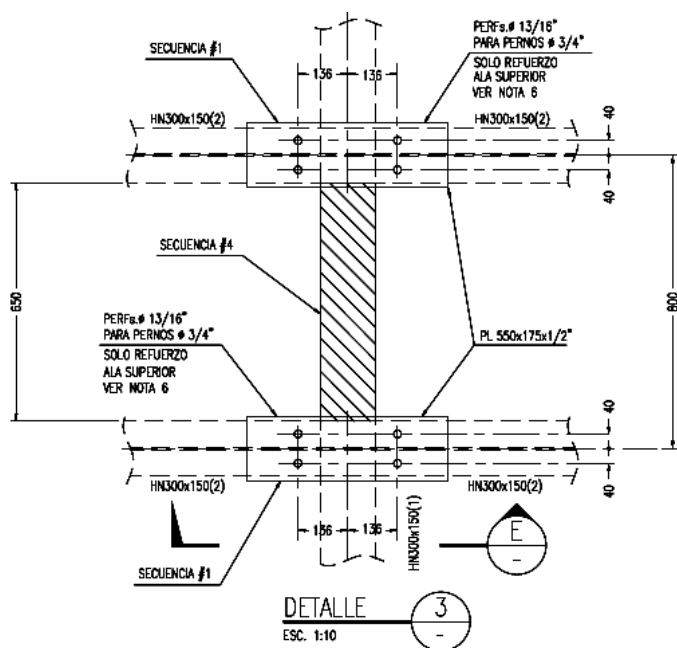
Vista en planta del esquema final de continuidad de conexión.
